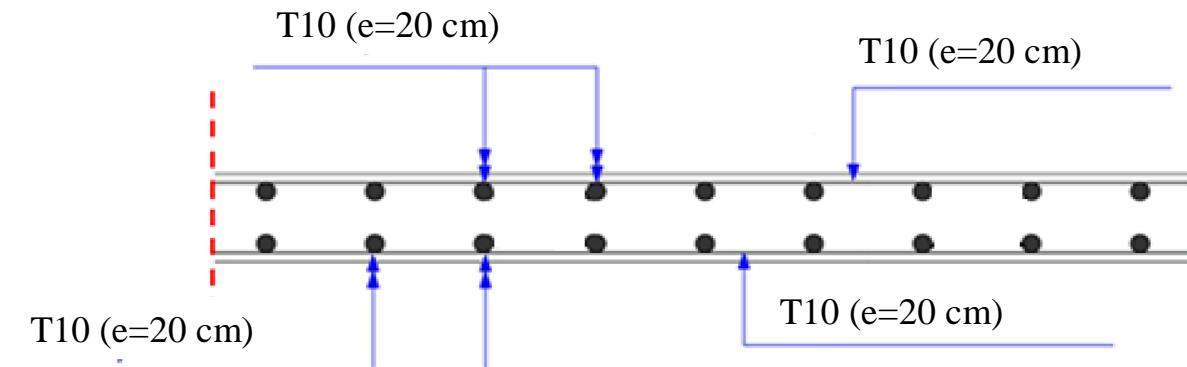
Dessin de ferrailage de la dalle pleine
